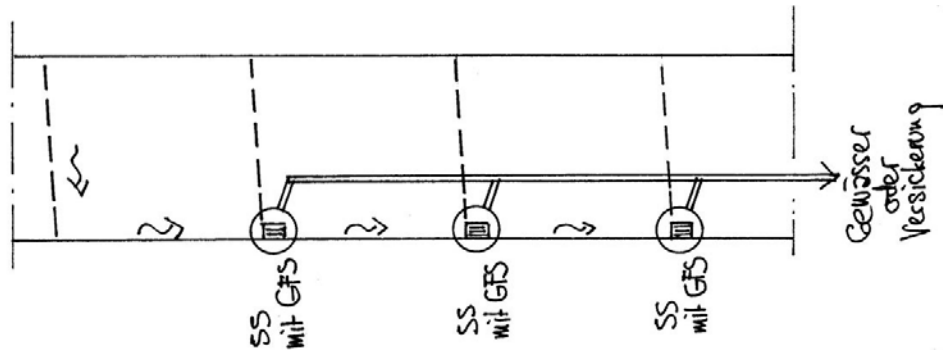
Alle Schlammsammler werden mit Geotextilfiltersäcken ausgerüstet.
